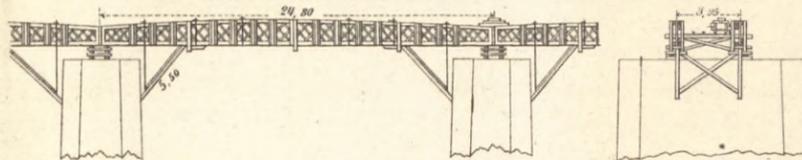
^d u. 1^e Aufstellung der Lehrgerüste.
